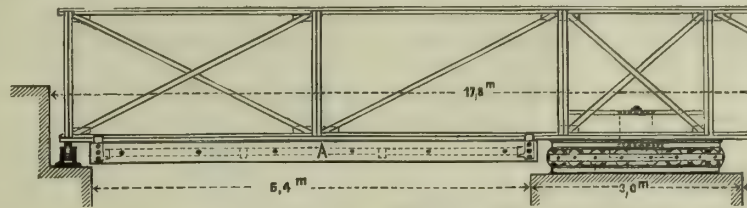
Ansicht der Brücke mit Weglassung des rechten Armes.
